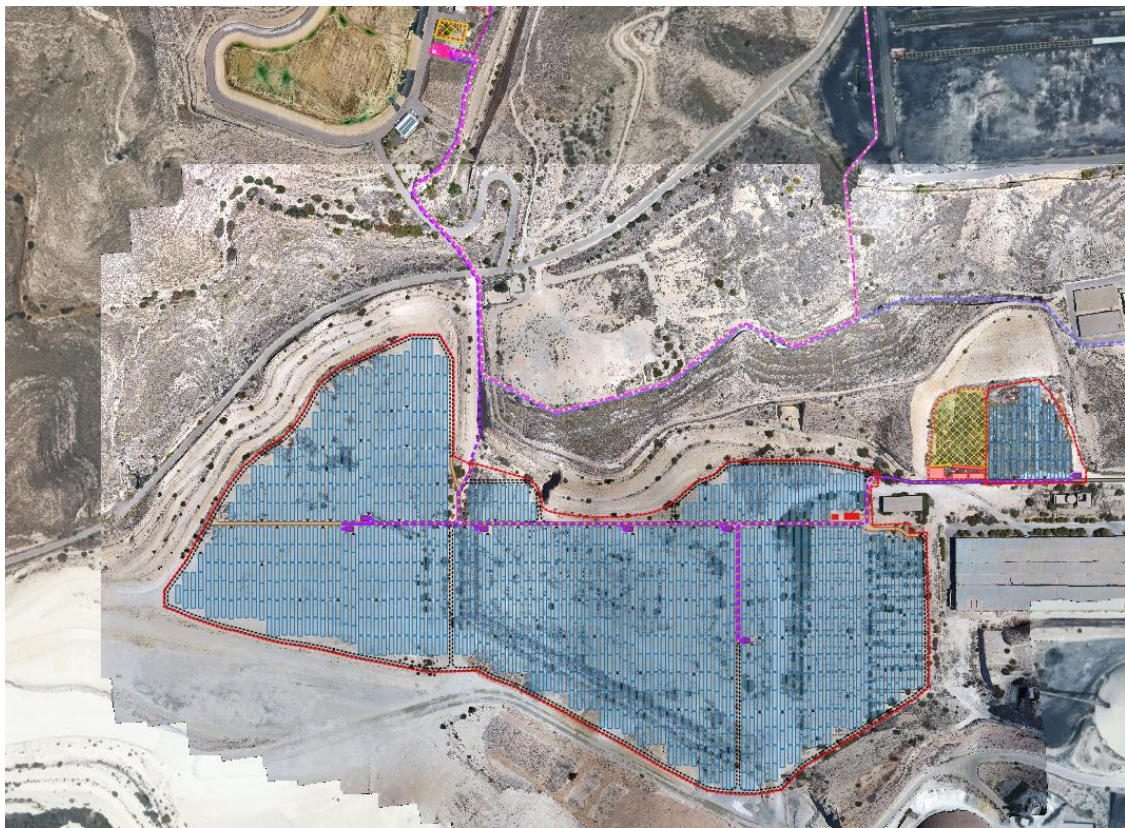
Planta fotovoltaica, detalle zona X sobre ortofoto
